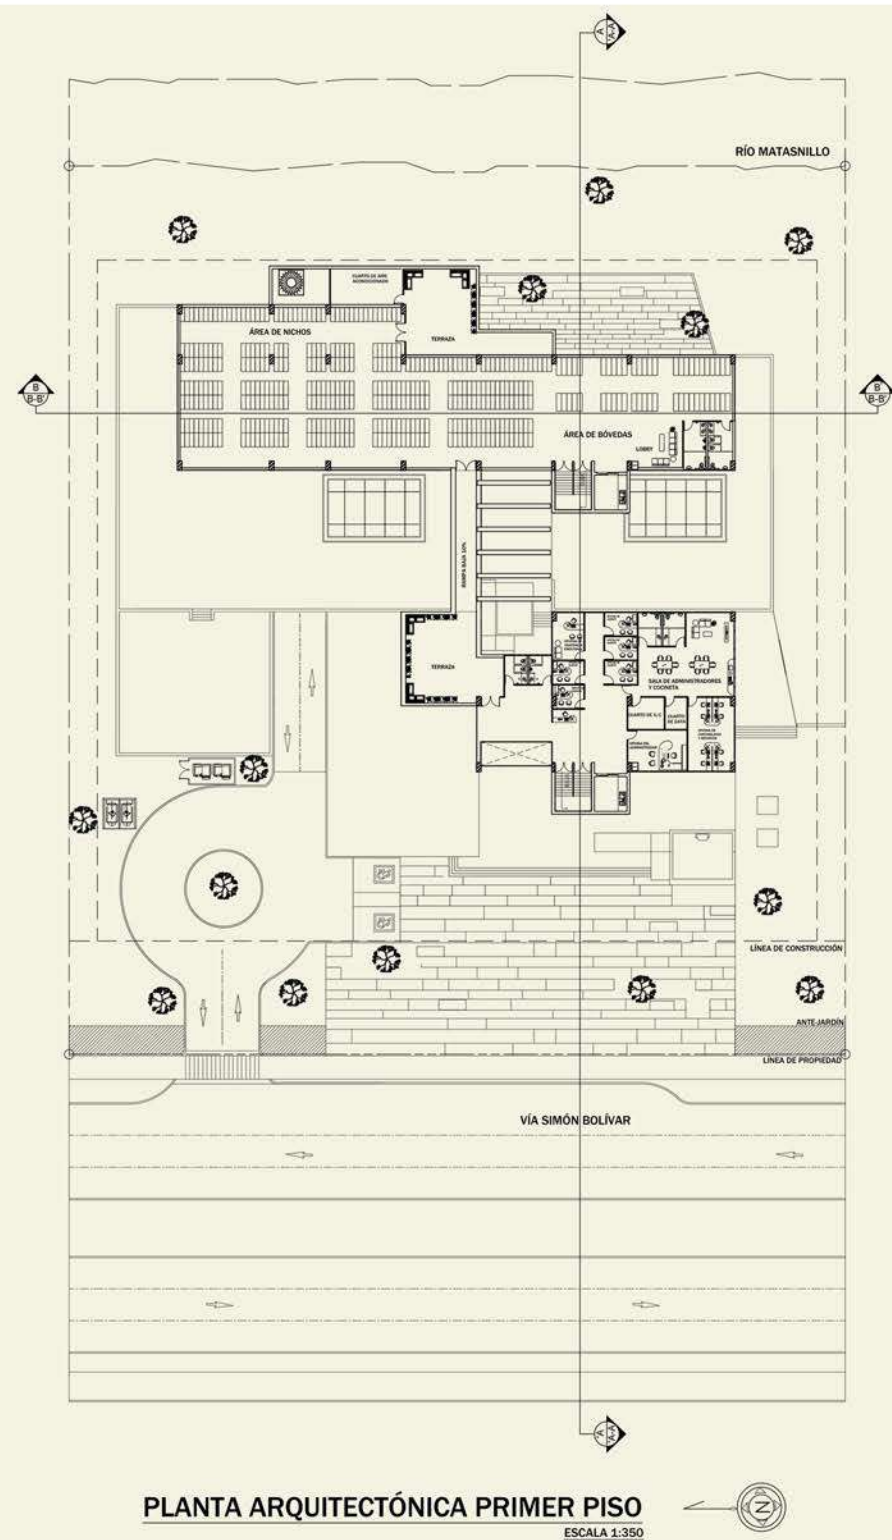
Planta arquitectónica primer piso. (Escala para plano 2x3)
